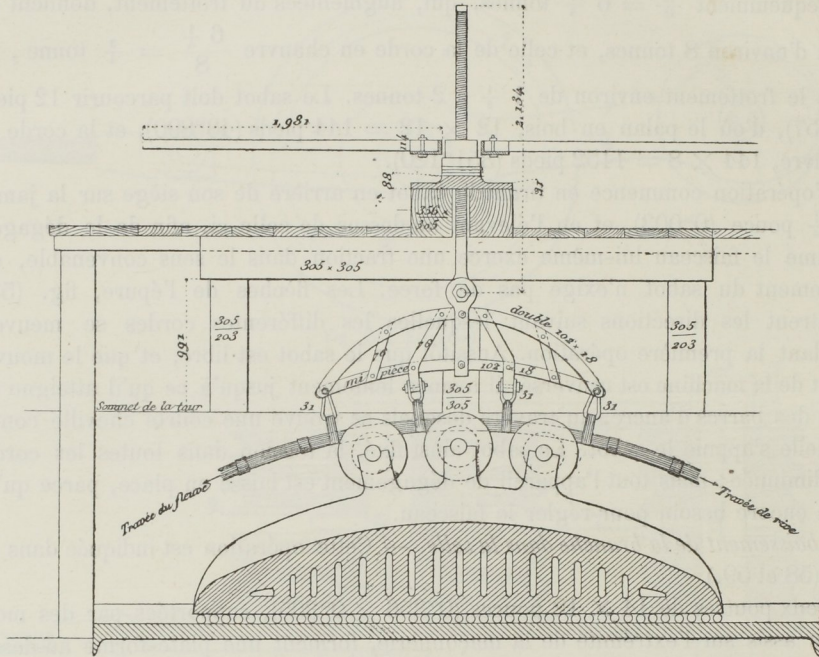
Coupe longitudinale. — Pose des faisceaux sur les selles.
